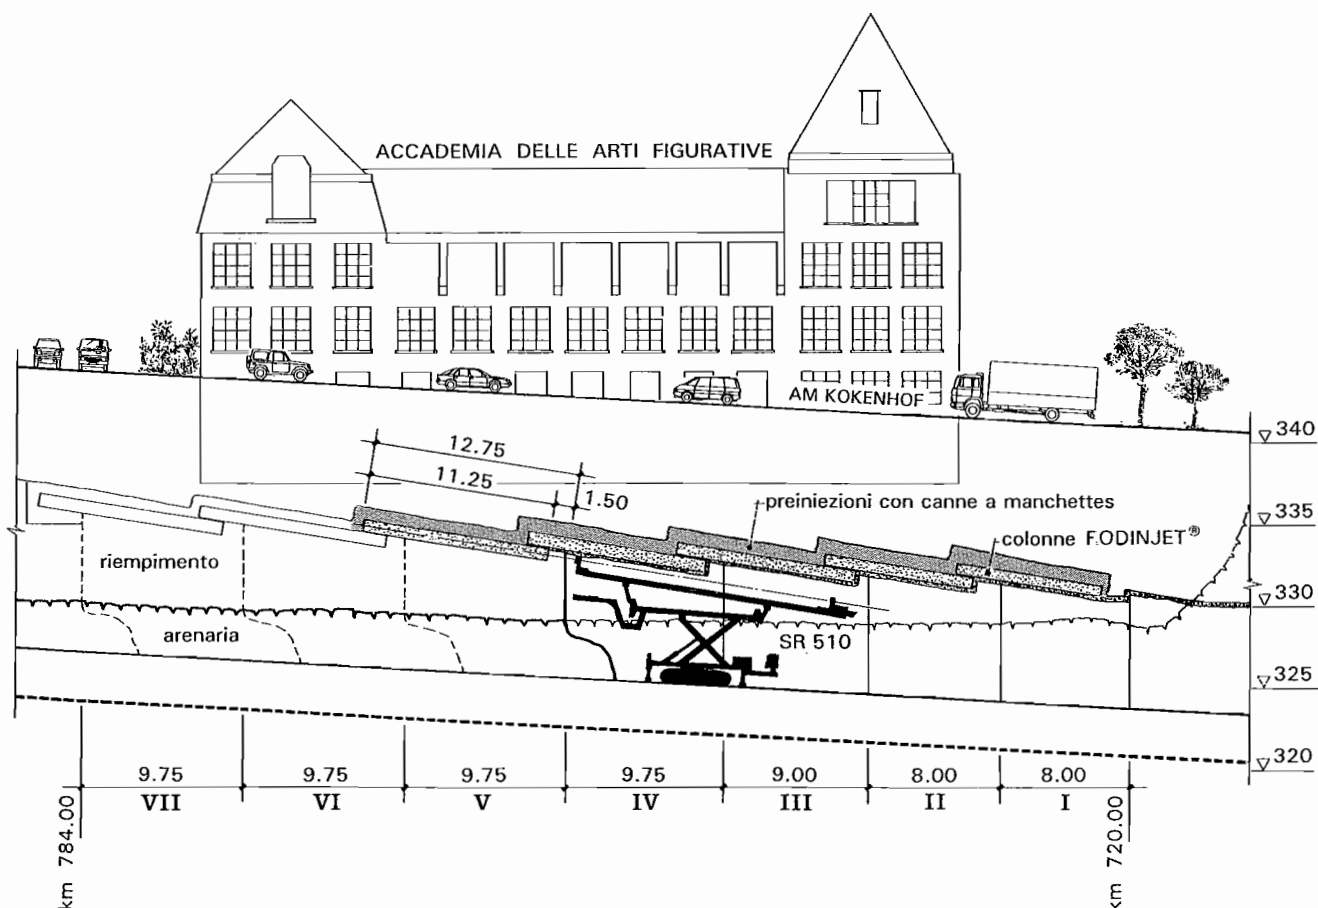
Galleria di Killesberg - Profilo longitudinale.
